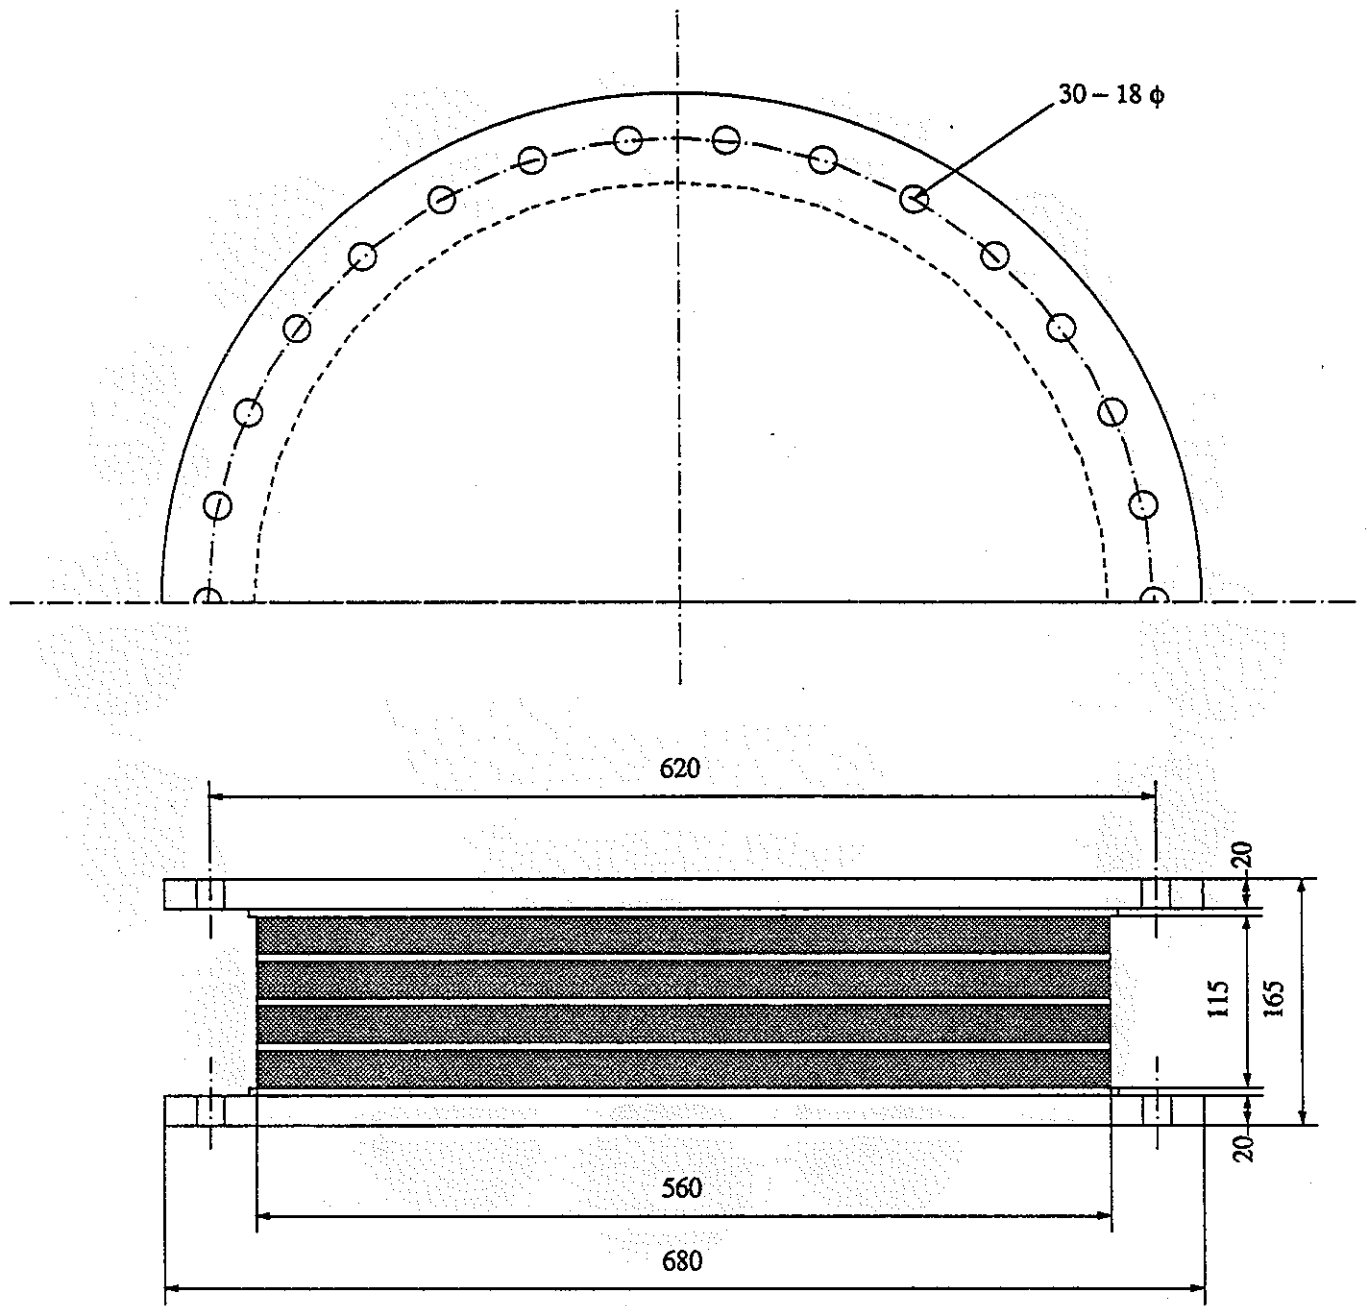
高減衰ゴム詳細図 (単位: mm)
